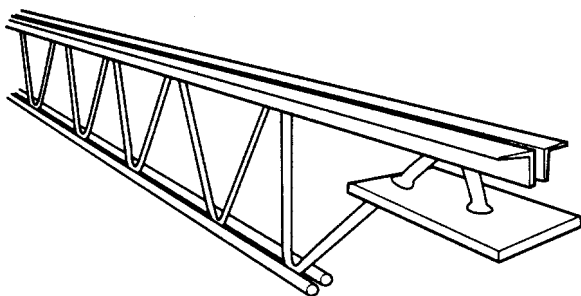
(b)(i)2 Construcción con viguetas de celosía con alma abierta.
